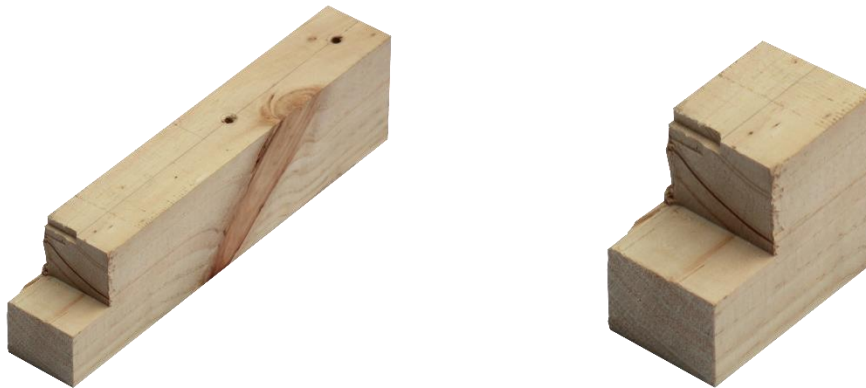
Detalle espiga 1 | No ingresa a la caja. Fuente: Elaboración propia.
